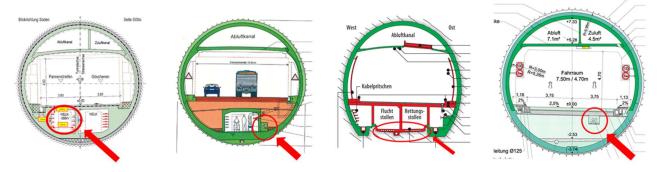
Représentation de variantes pour l'agencement de type A, route (de gauche à droite) : second tube du tunnel routier du Saint-Gothard, tunnel de l'Uetliberg, tunnel du San Bernardino, tunnel du Pfänder
